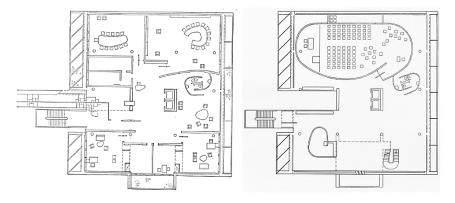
Планы 1-го и 2-го этажей здания Ассоциации владельцев мельниц в Ахмадабаде⁴ Fig. 4. Plans for 1, 2 floors of the Mill Owners' Association Building in Ahmedabad
